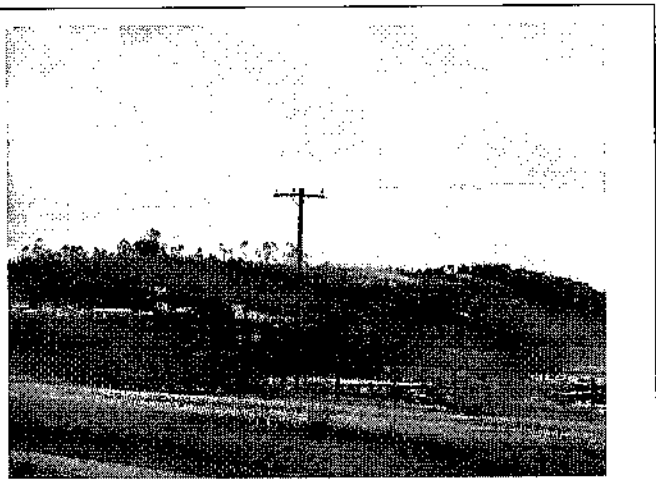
Canteiro de Obras da Constran – Lote 30/SC
